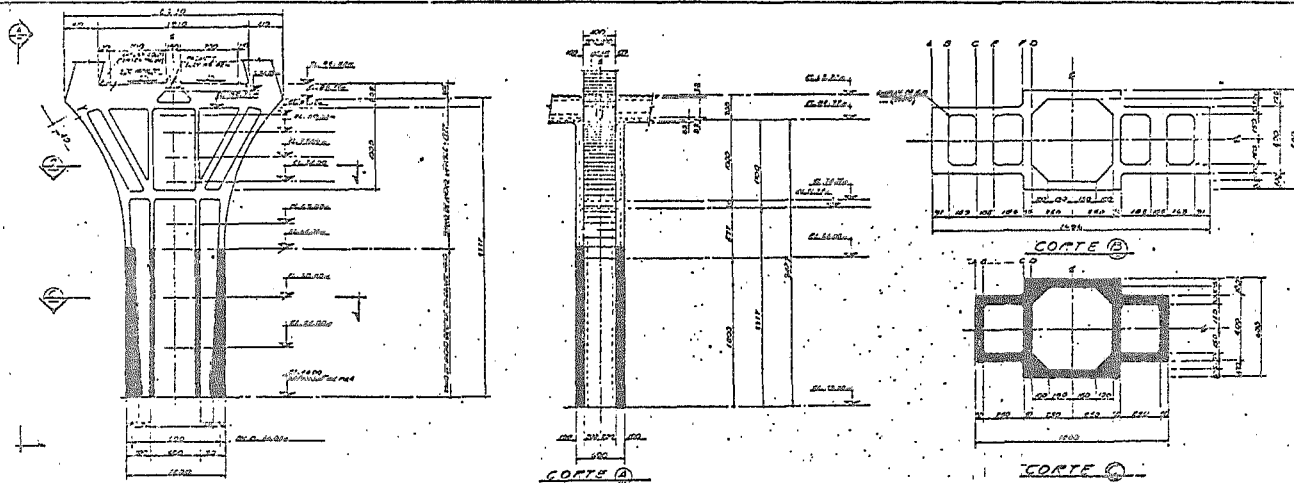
COLADO DEL NIVEL 48 AL 66. PILAS 4 Y 5
